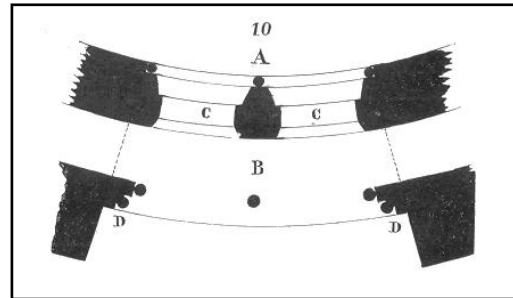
Plan d'une fenêtre des transepts circulaires de la cathédrale de Noyon. (Source: dictionnaire raisonné d'architecture)
